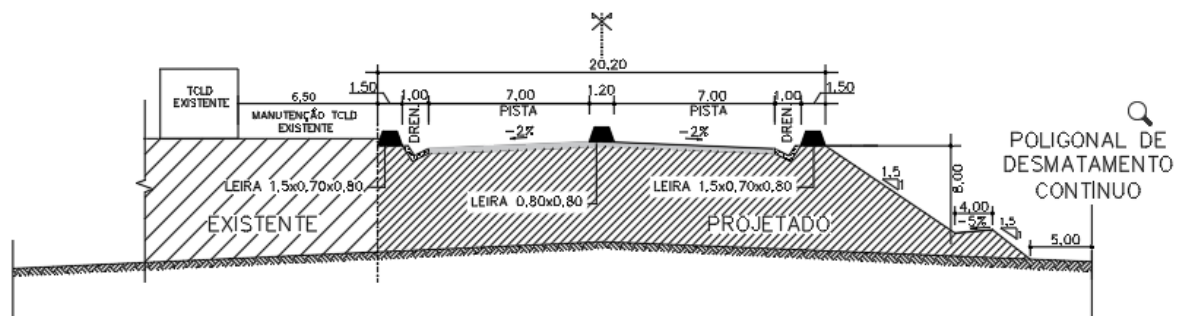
Vista da Seção Tipo Projetada da estrada – SEÇÃO DE ATERRO
